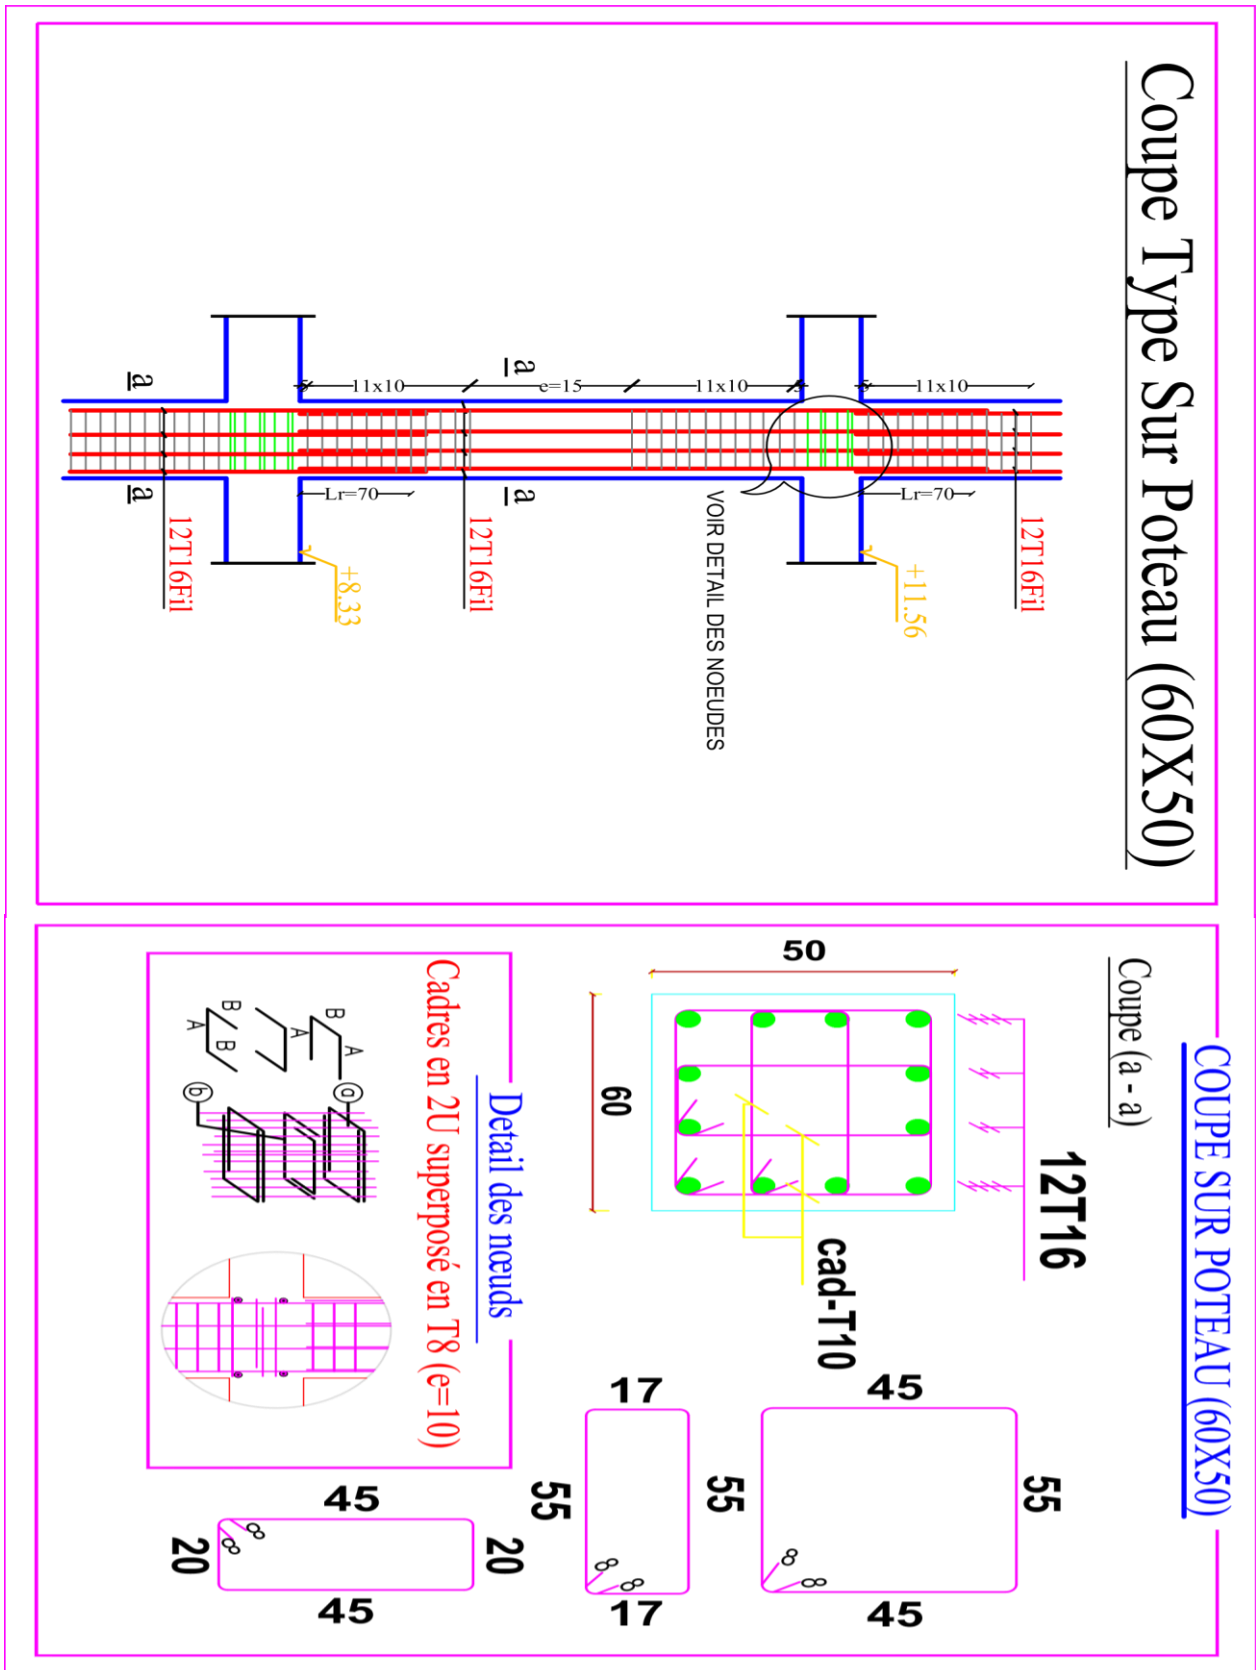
Schéma de ferrailage des poteaux (60x50)
